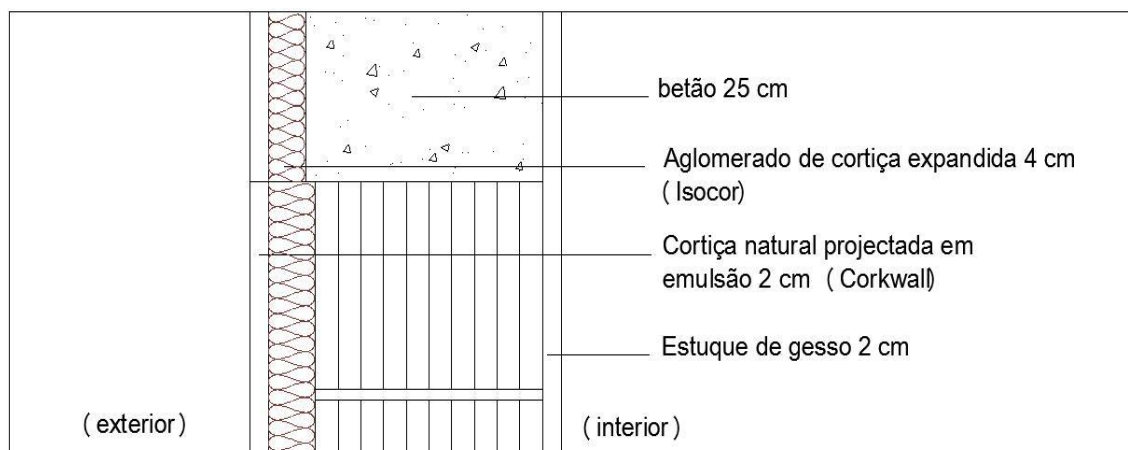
Pormenor construtivo de zona de ponte térmica plana (pilar ou talão de viga) proposta na solução 2
